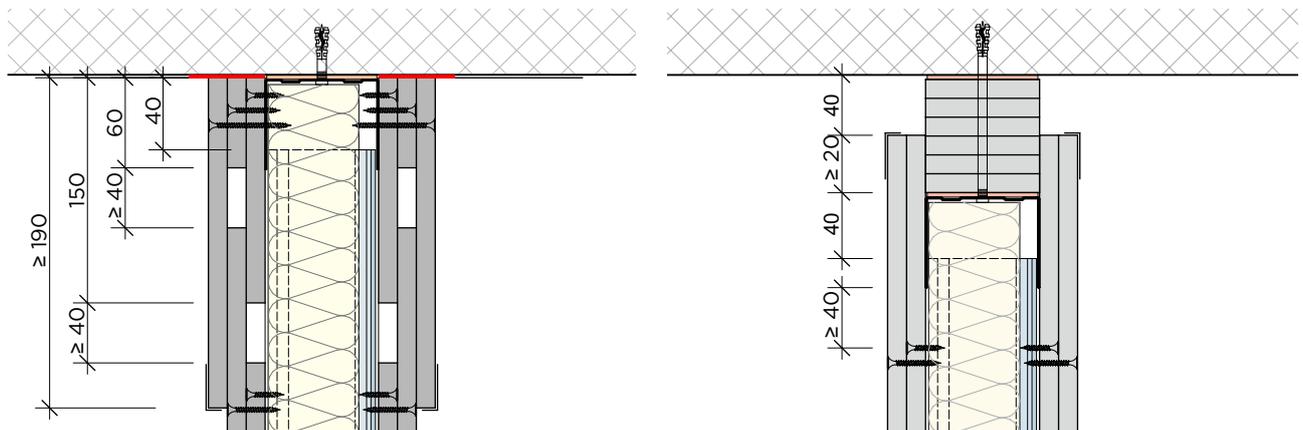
exécution de raccords coulissants au plafond pour des flexions de plafond ≤ 40 mm
